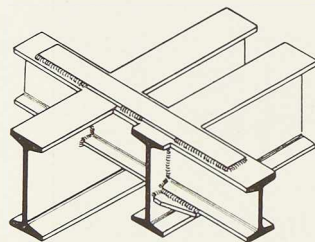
Appui d'une solive sur une poutre double. On remarque les joints soudés et les renforcements destinés à assurer la continuité.
